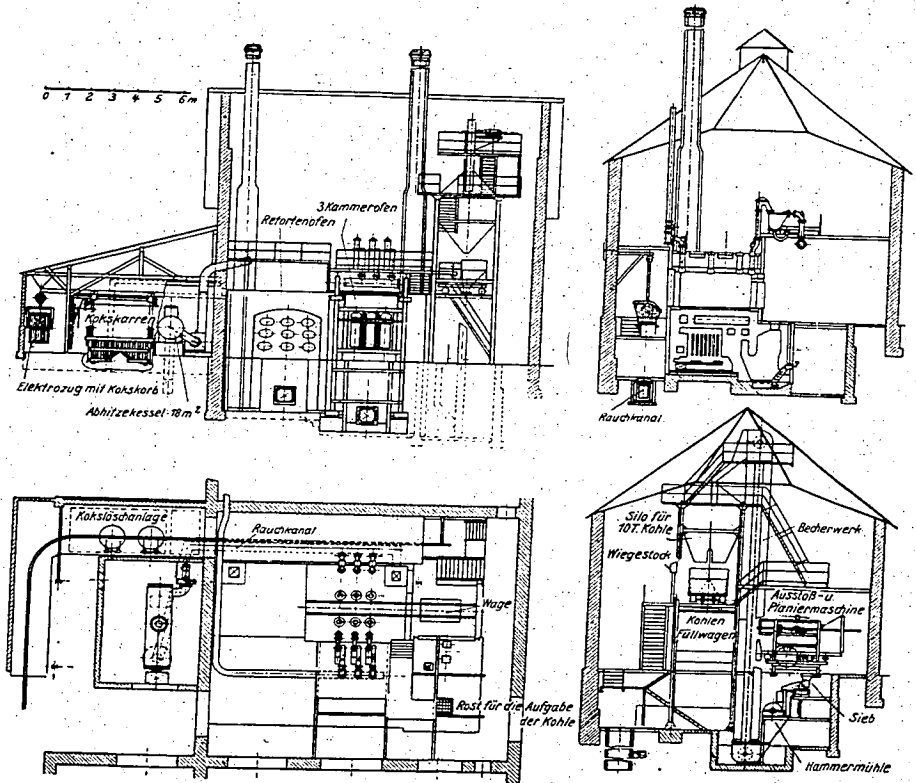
Retorten und Kleinkammern im Gaswerk Langenthal mit angepaßten Fördermitteln.
